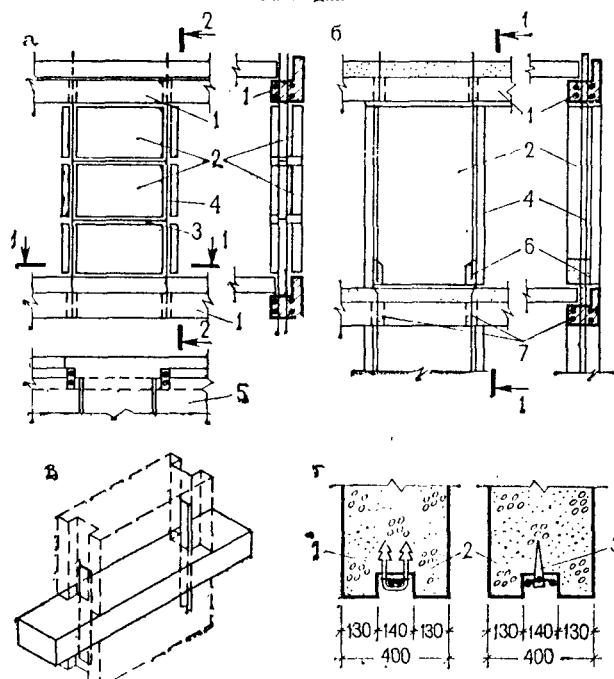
Антисейсмические мероприятия при конструировании крупноблочных зданий
